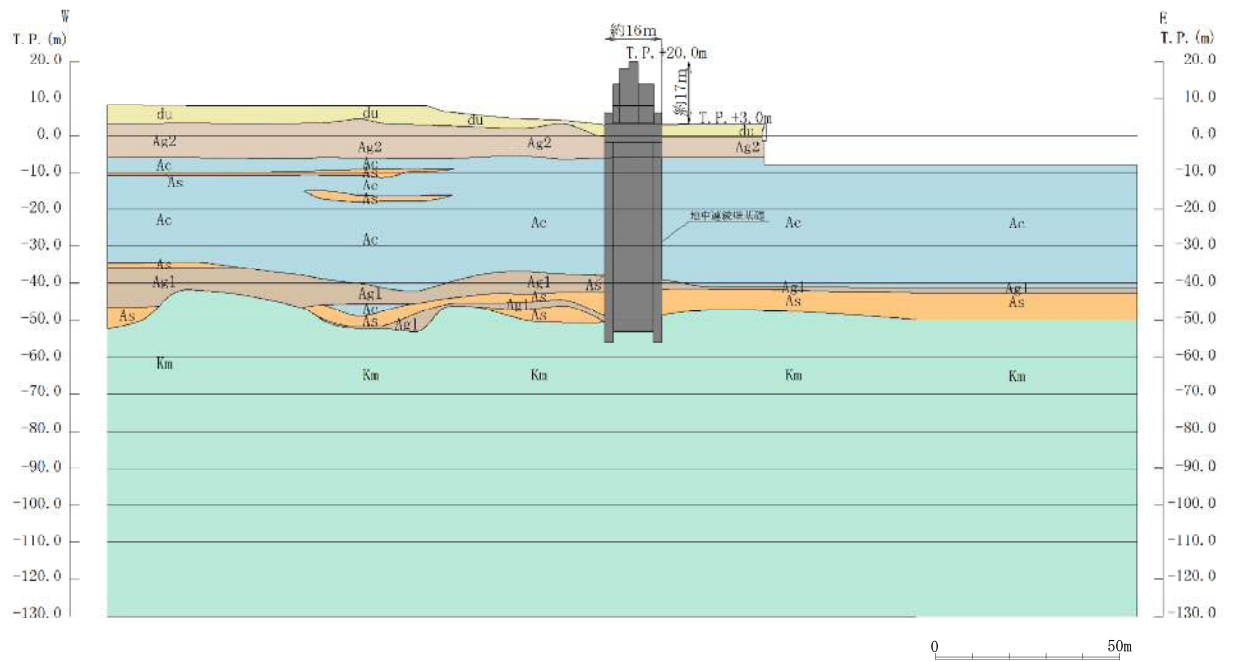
(2) 鋼製防護壁 評価対象断面図 (②-②断面)
